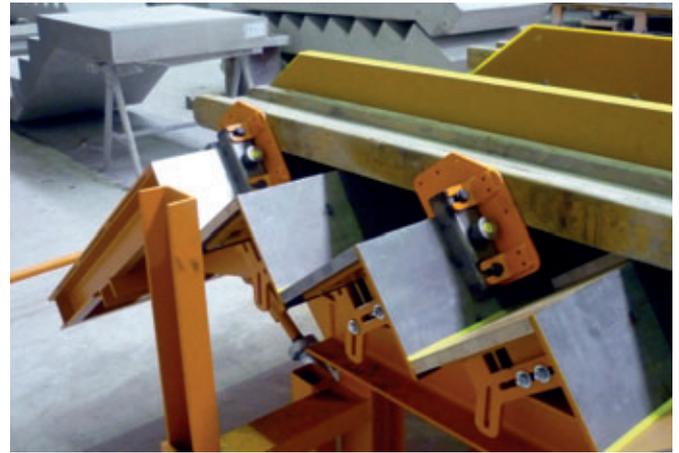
Detailansicht – Fixierung des Sägezahnprofils
